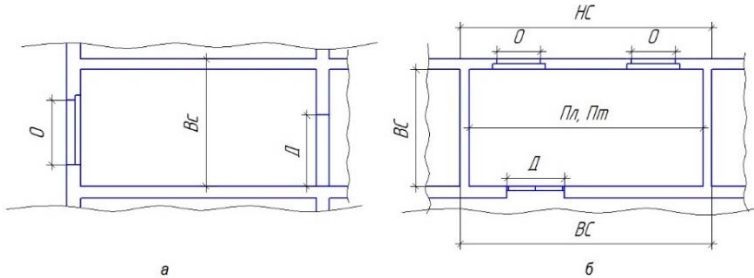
Схема наружных ограждений при теплотехнических расчетах офисного помещения: а – разрез здания; б – план;
